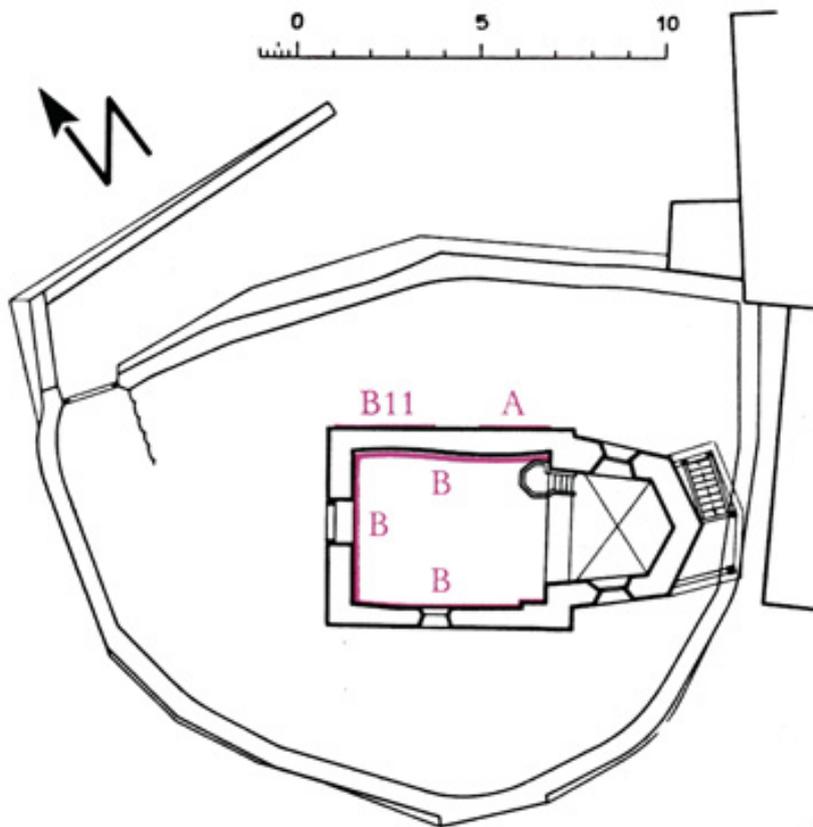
Stugl, Grundriss (Raimann 1983)
